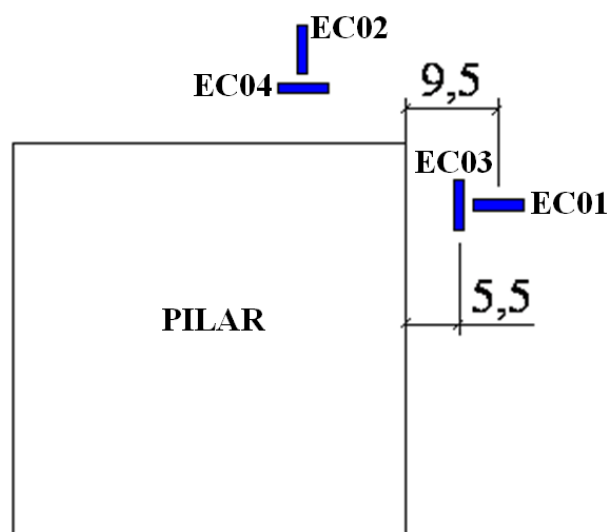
Extensometria do concreto no modelo LR-S
